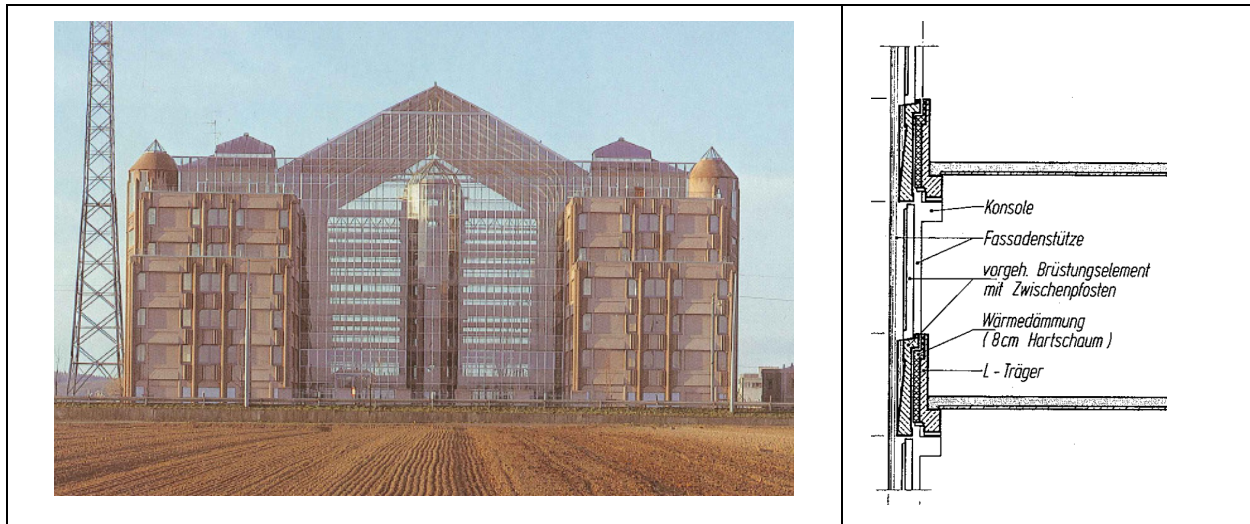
1: Ansicht und Detailschnitt Fassade [Quelle: Ed. Züblin AG].
